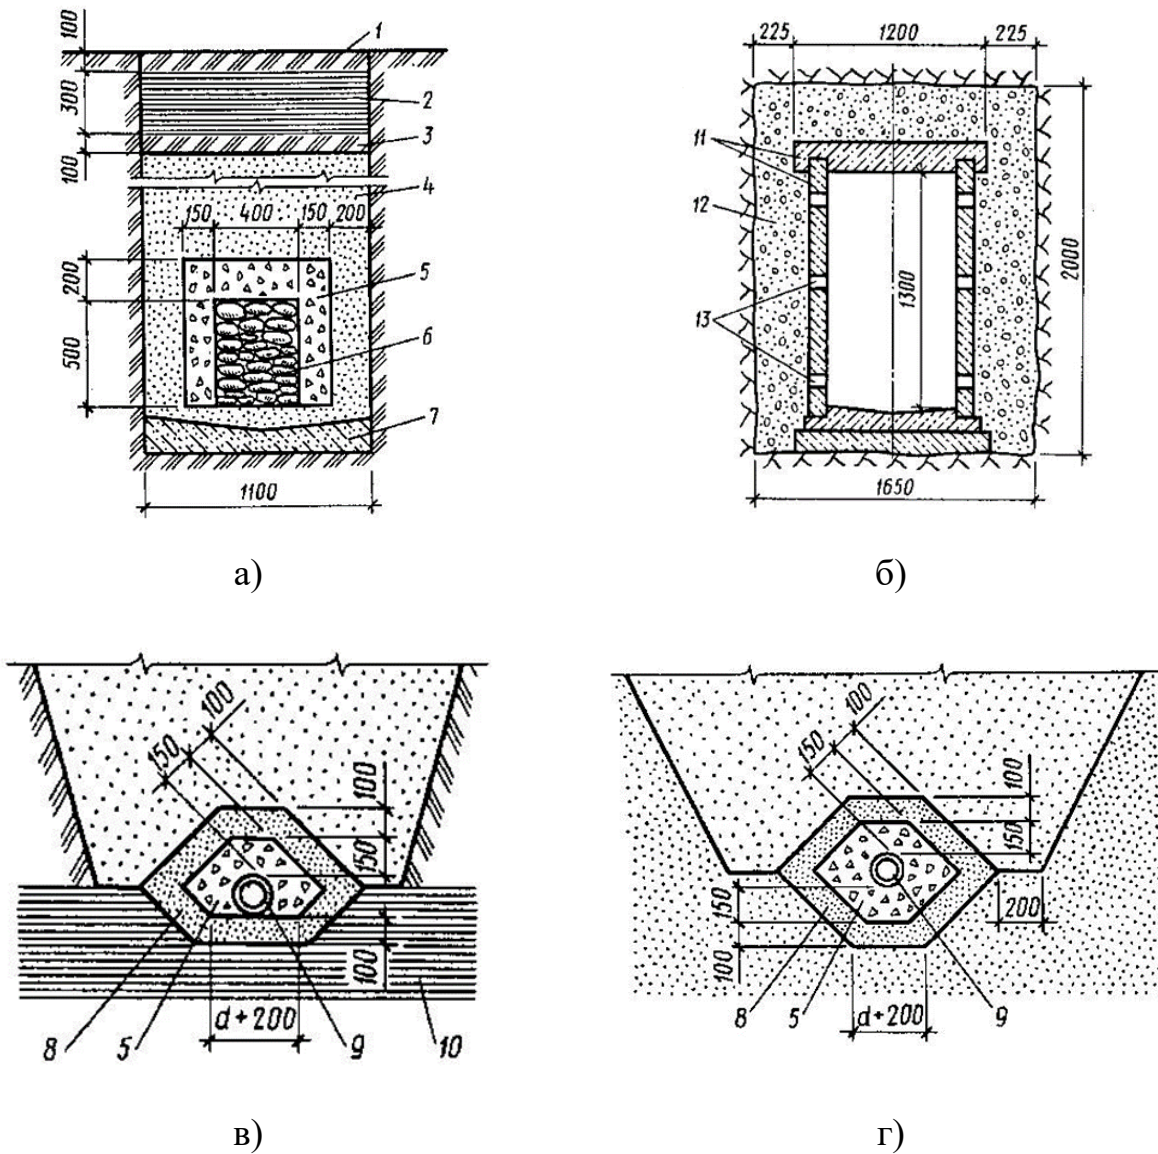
Види дренажів: а – закритий безтрубчастий; б – дренажна галерея; в – трубчастий досконалого типу; г – трубчастий недосконалого типу; 1 – дерен корінням вниз; 2 – ущільнена глина; 3 - дерен корінням вгору; 4 – зворотна засипка з піщаного ґрунту; 5 – щебінь; 6 – кам’яна кладка; 7 – глинобетонна подушка; 8 – пісок середньої крупності; 9 – труба; 10 – водоупор; 11 – оброблення із збірних залізобетонних елементів; 12 – дренажна засипка; 13 – отвори для води
